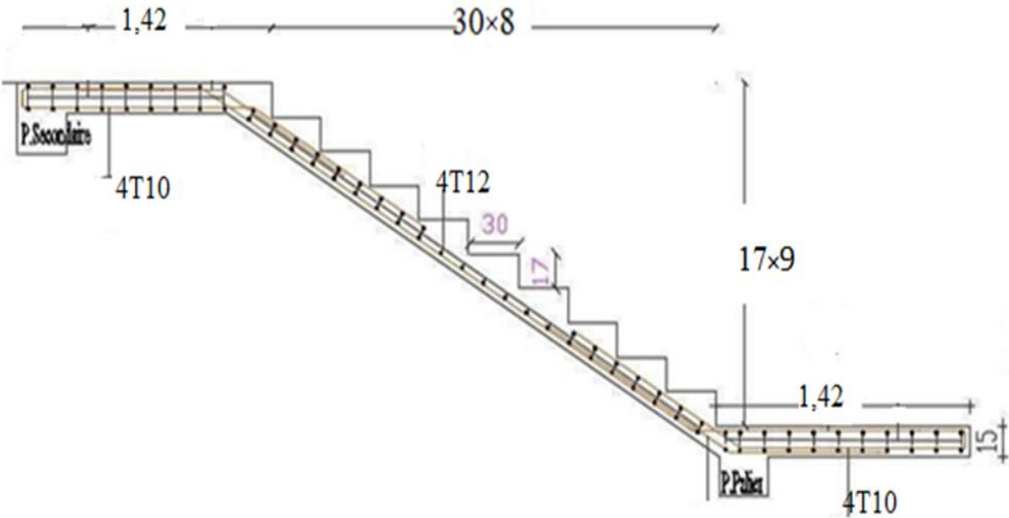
IV.15 Schéma de ferrailage d'escalier(type2).
